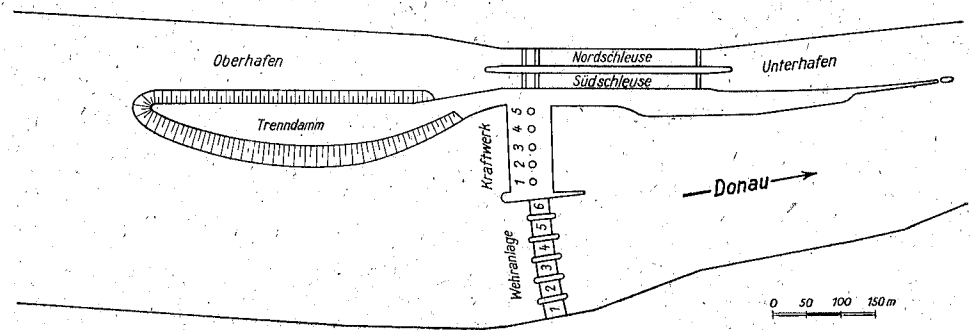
Donaukraftwerk Jochenstein. Grundriß.
